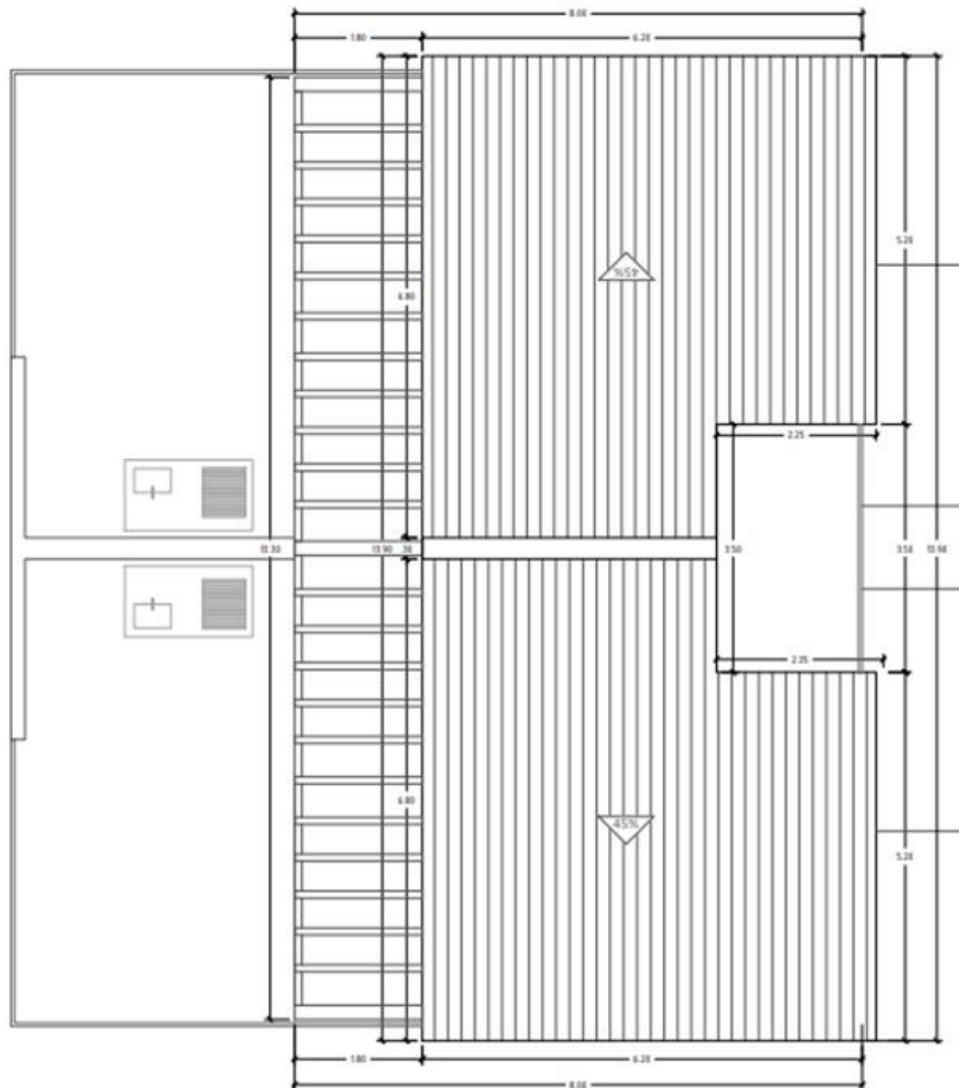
Planta Arquitectónica de techo Esc.1:50, Proyecto Romeo e Giulietta, 2020
